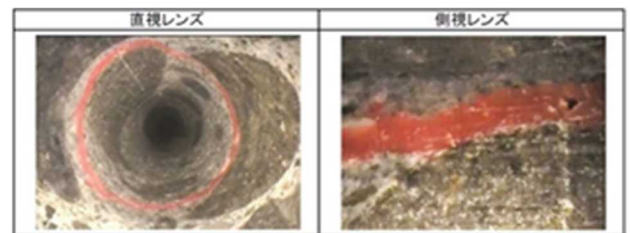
ひび割れ箇所に残存した着色樹脂（例）
